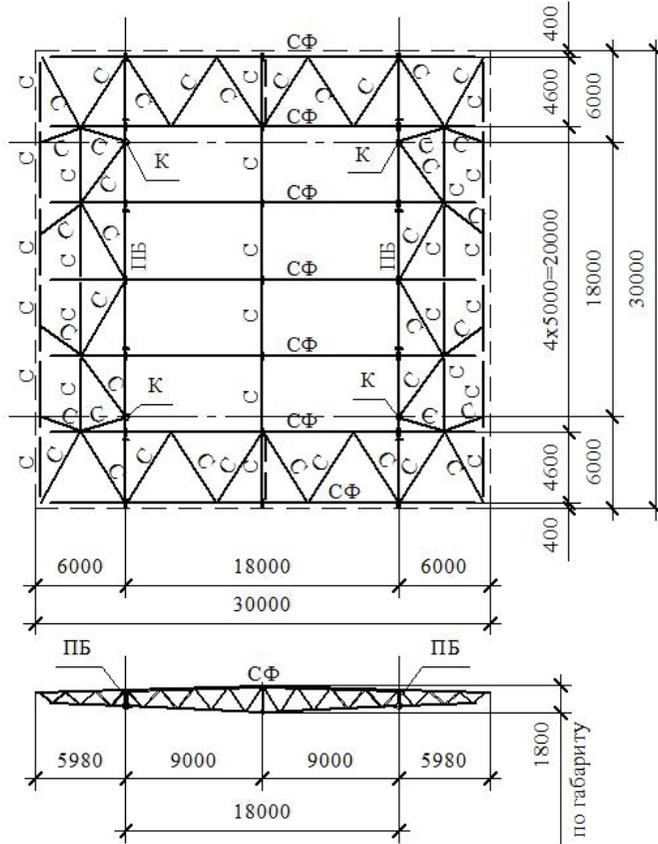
Схема покрытия с подстропильными балками и стропильными фермами (Вариант 3).
